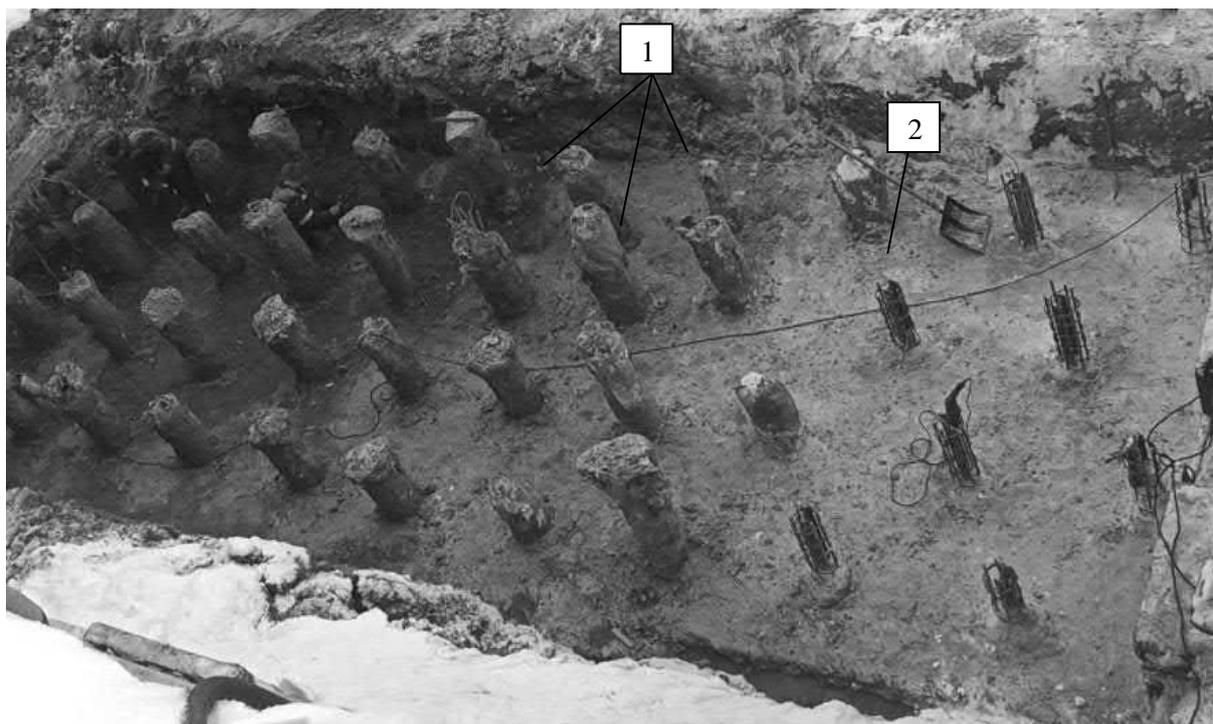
Свайное поле под монолитный железобетонный контрфорс:
